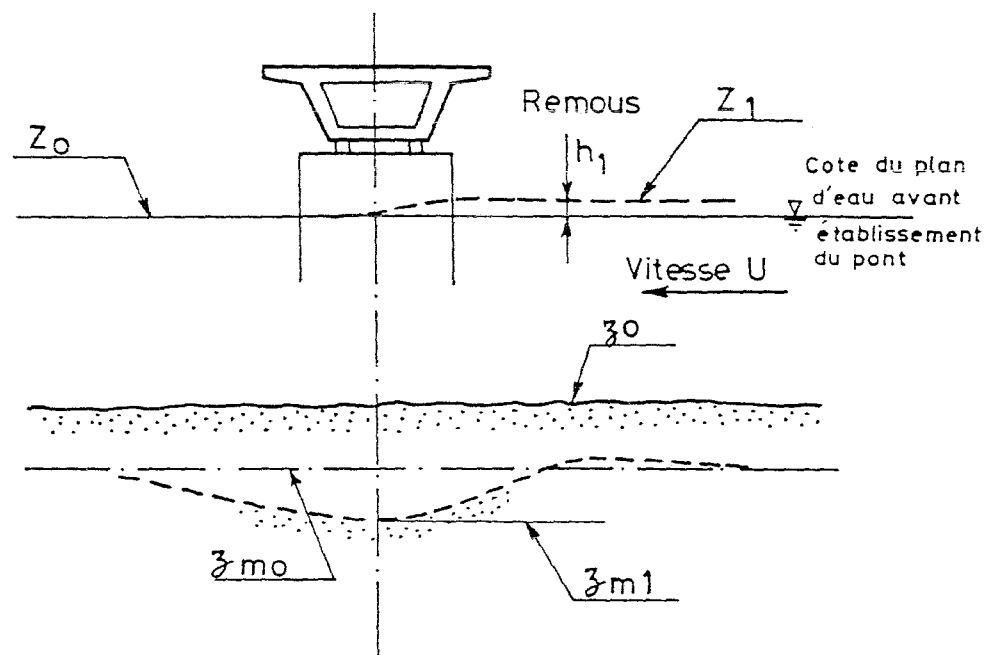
Remous d'exhaussement du plan d'eau en amont du pont
